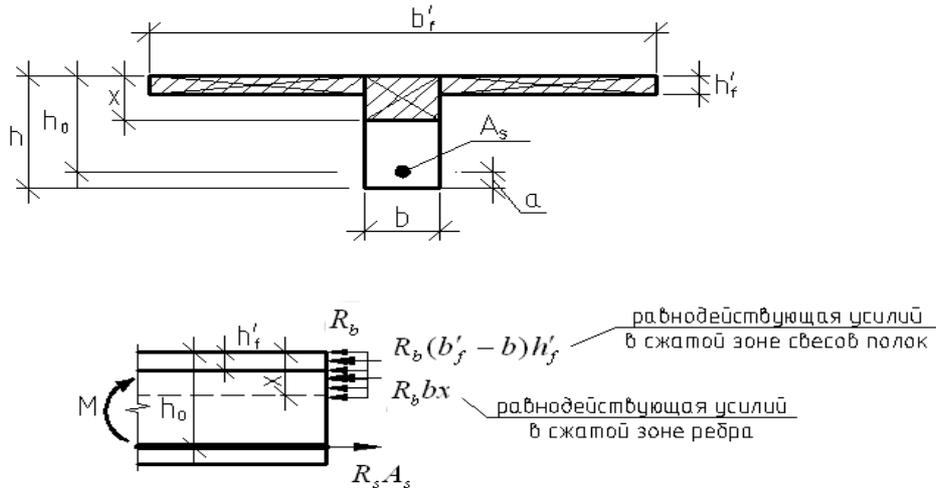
К расчету растянутой арматуры в элементах таврового профиля
